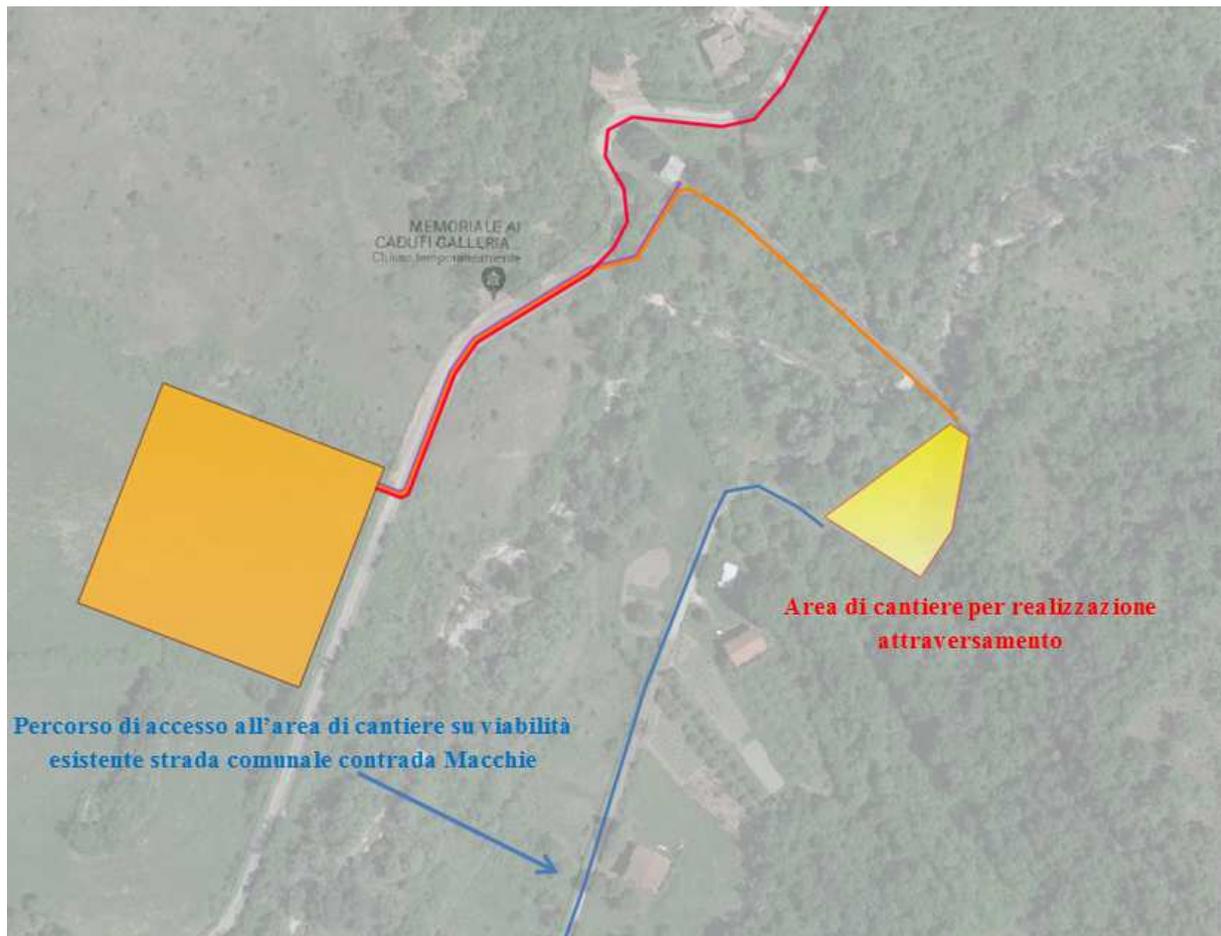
Localizzazione Cantieri Attraversamento - Stralcio 3
